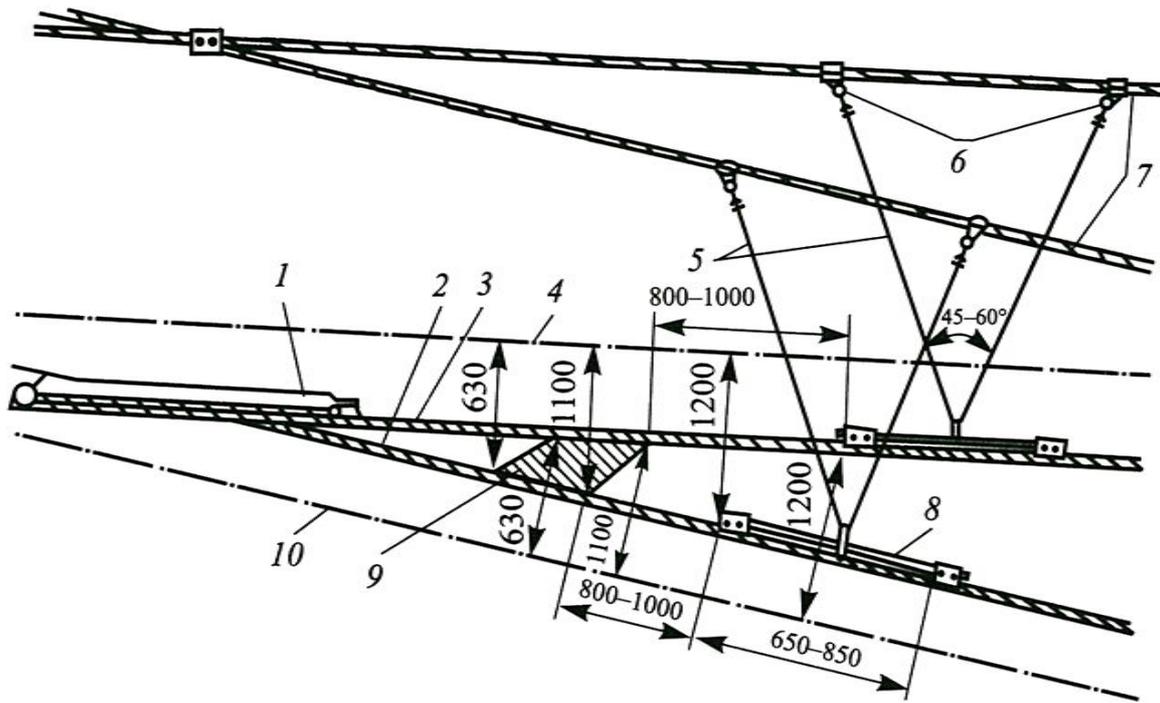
Скользящие струны на воздушной стрелке: 1 — ограничительная накладка; 2 и 3 — контактные провода отклоненного и прямого путей; 4 и 10 — оси прямого и отклоненного путей; 5 — скользящие струны (БМ-4); 6 — зажим с ушком К-037 (К-040); 7 — несущие тросы; 8 — скользящий диаметр 12—14 мм длиной 700 — 900 мм; 9 — зона подхвата
